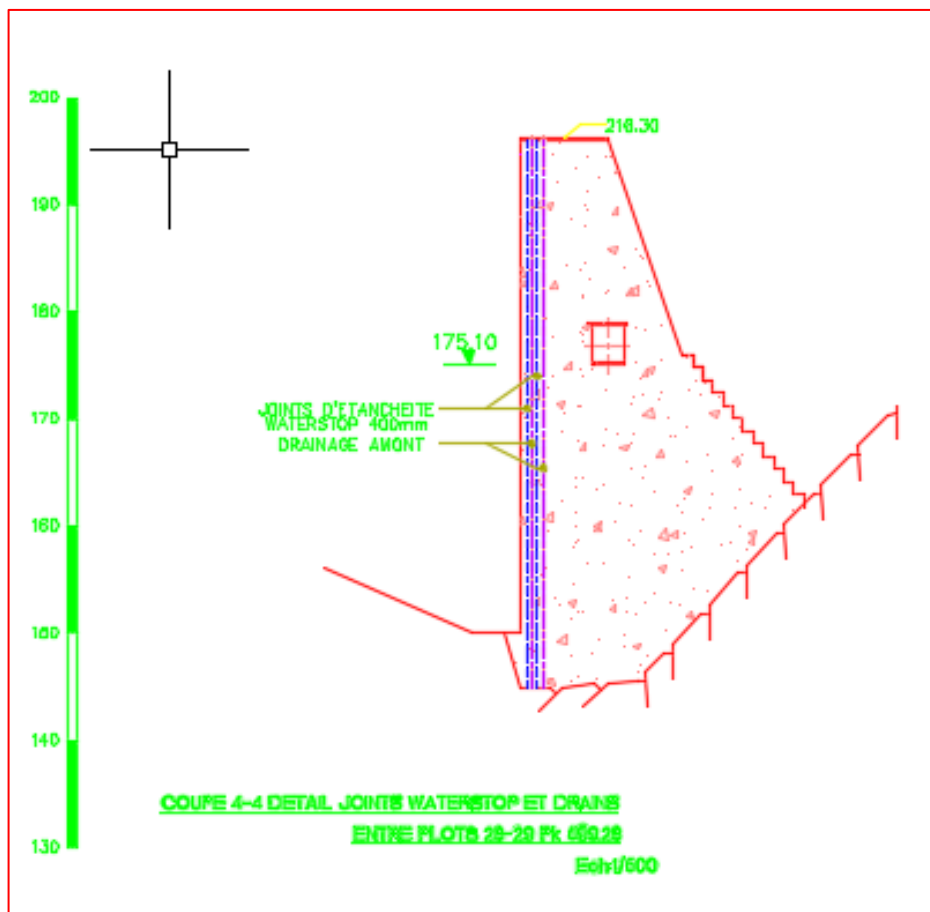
Coupe transversale montrant un joint d'étanchéité Waterstop
